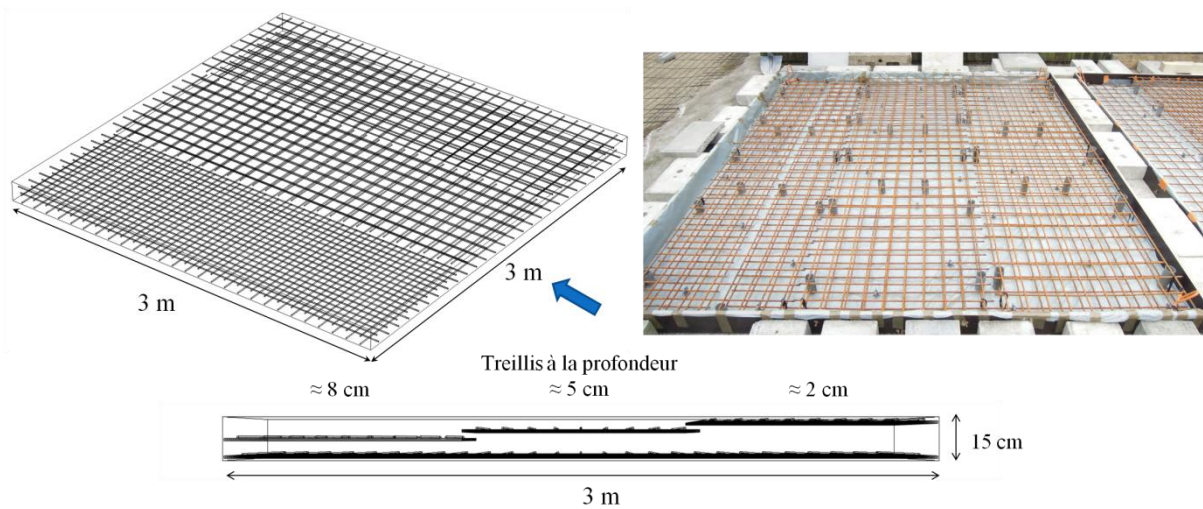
Disposition et profondeurs du ferrailage de la maquette en béton armé avant coulage
